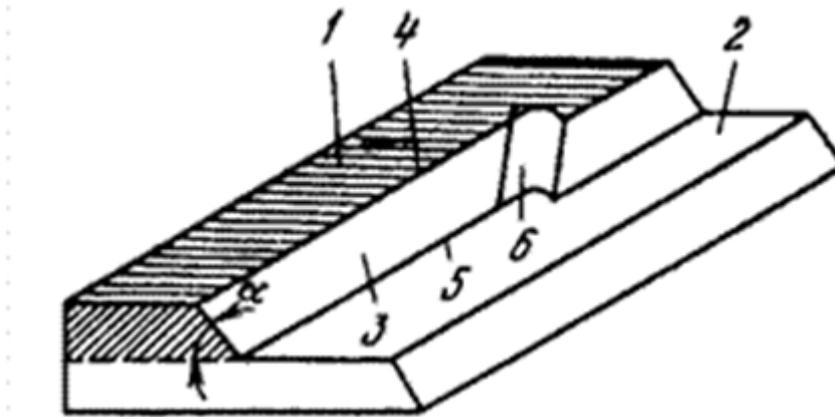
Элементы уступа: 1 - верхняя площадка уступа; 2 – нижняя площадка уступа; 3-откос уступа; 4 – верхняя бровка уступа; 5 – нижняя бровка уступа; 6 – забой уступа
